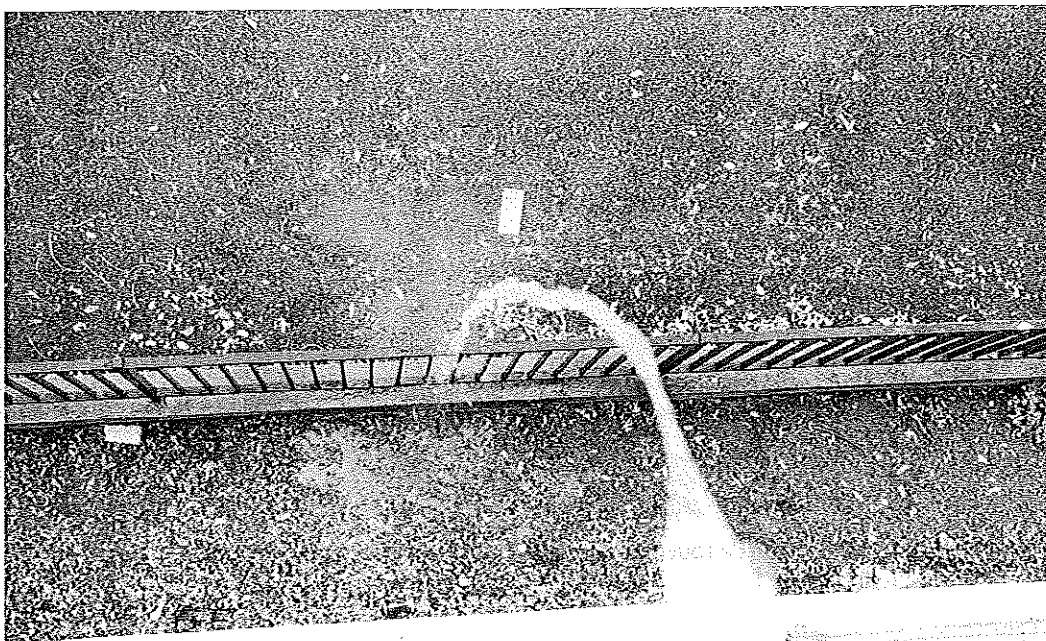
Essai de fonctionnement du trop-plein ci-dessus (sortie en façade). © J. Putatti
